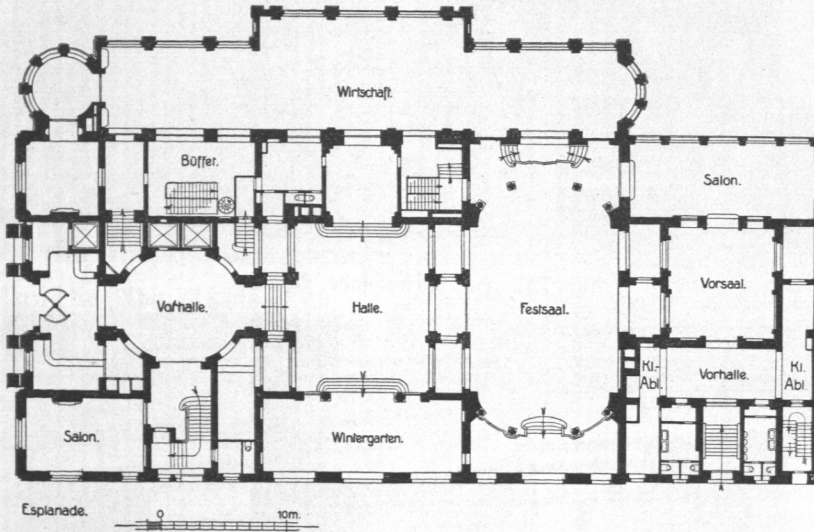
Hotel Esplanade, Erdgeschoß, Grundriß.
